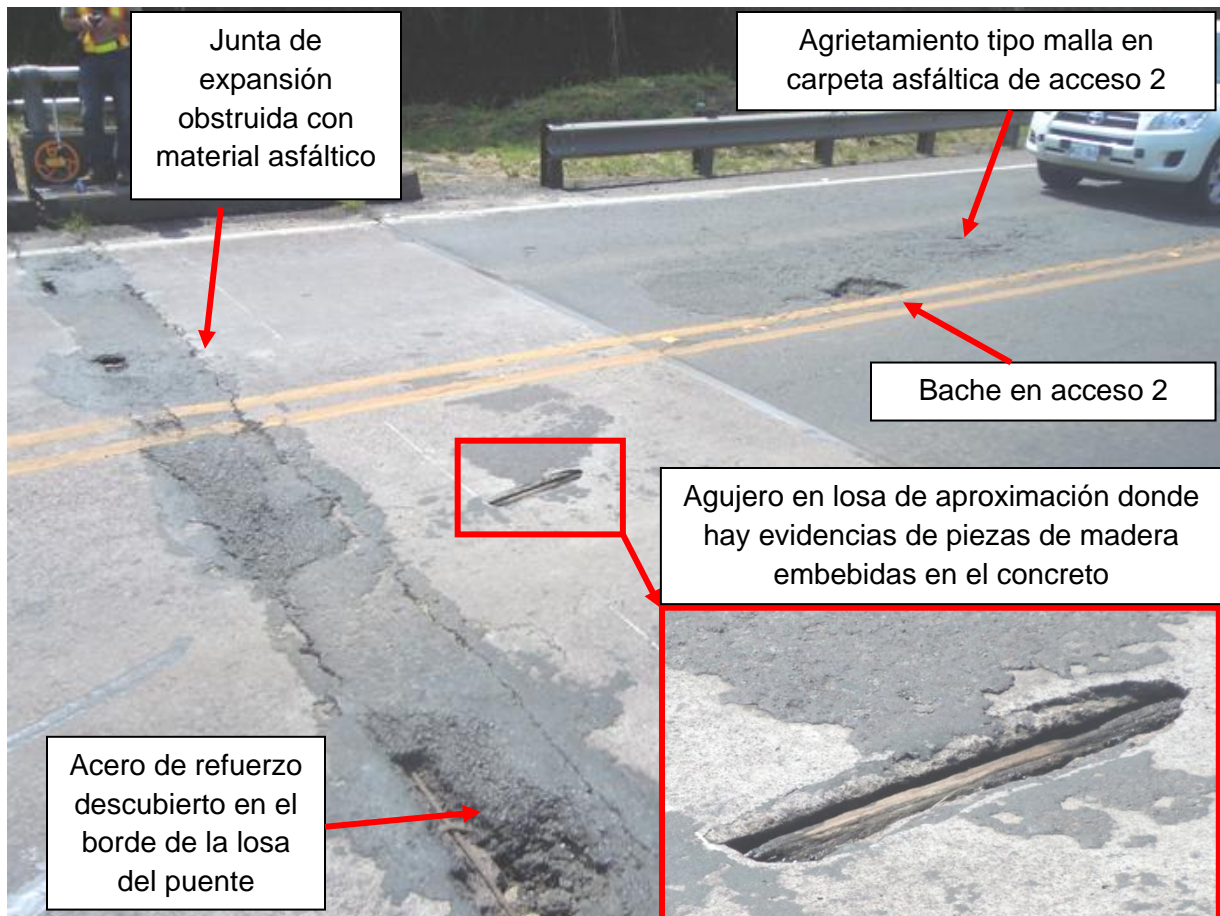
Baches y agrietamiento tipo malla típicos en acceso 2. Agujero en losa de aproximación del acceso 2. Junta de expansión sobre el bastión 2 obstruida con material asfáltico y acero de refuerzo descubierto.
